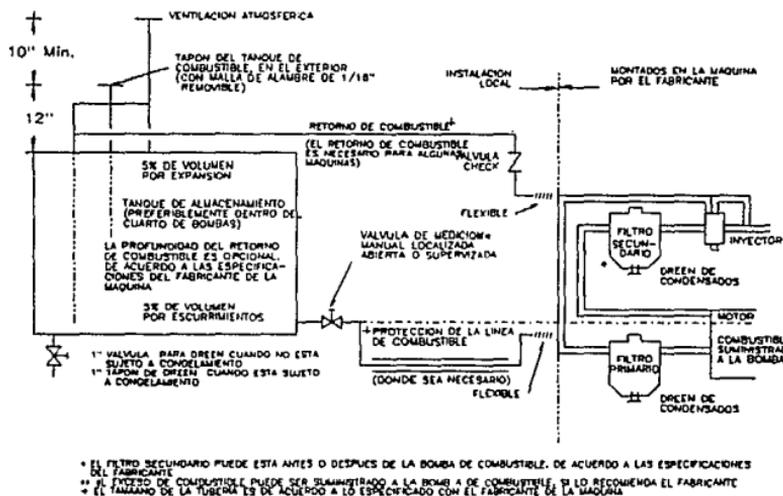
Sistema de combustible de una motor diesel para bomba contra incendio. [NFPA 20, figura A-8-46]
